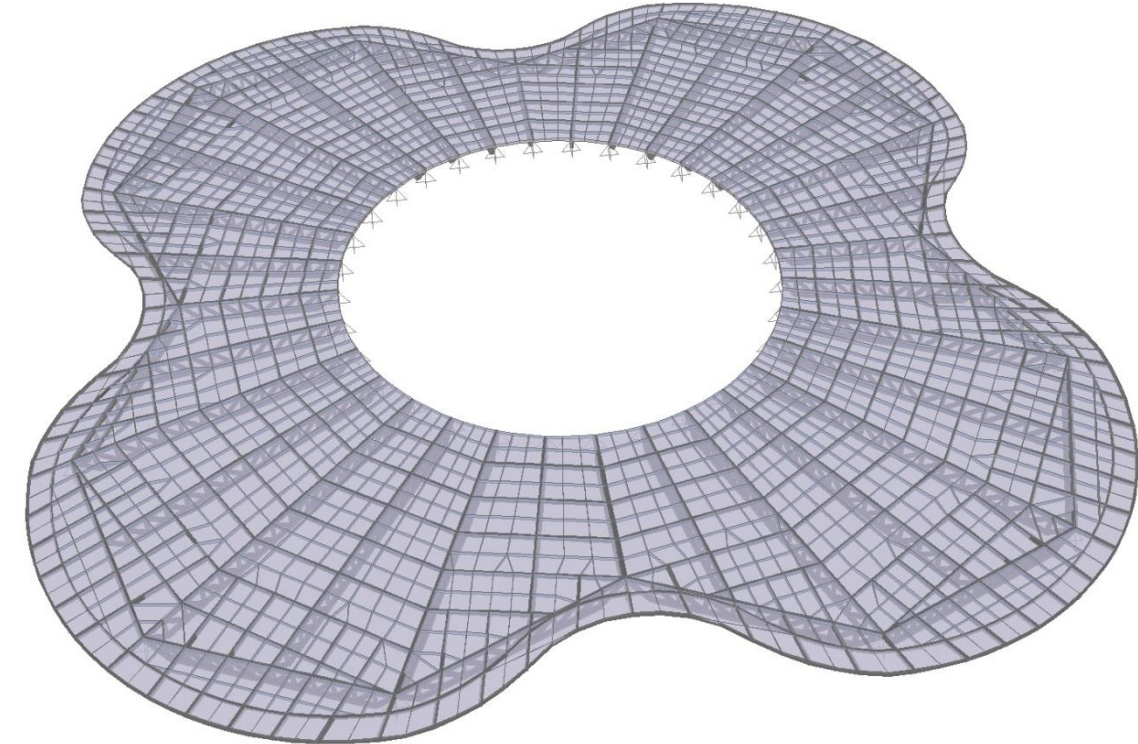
Modelización 3D estructural del forjado con losa de la planta tipo 1
